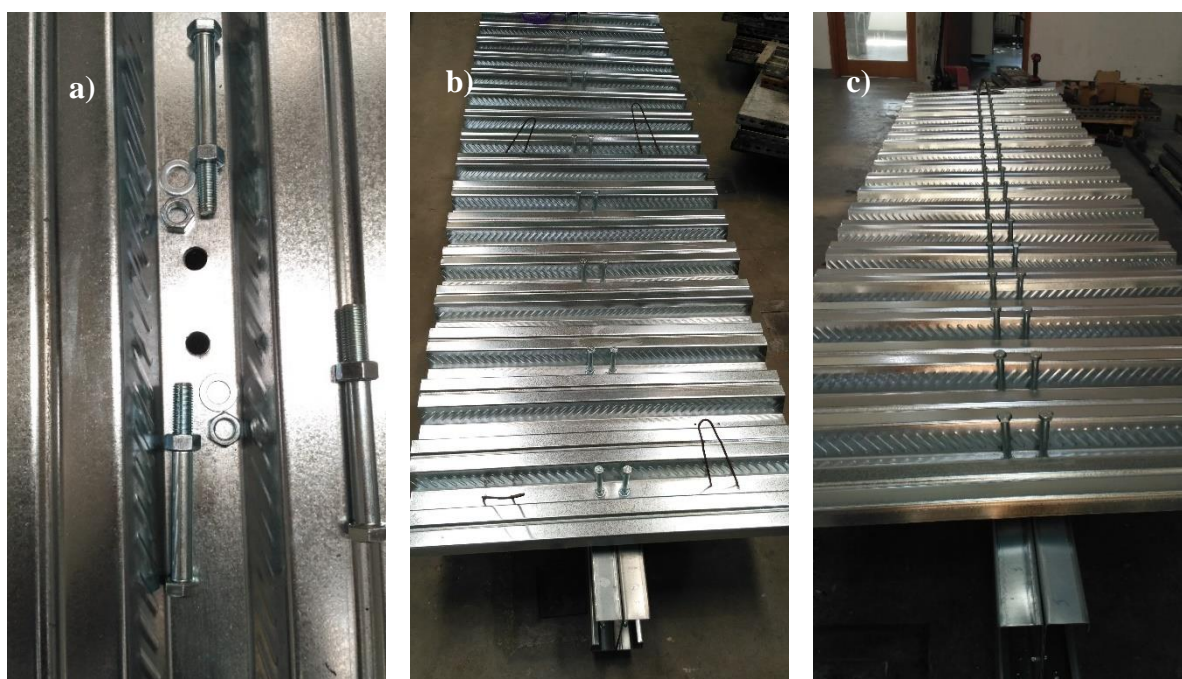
a) Esquema de aplicação do conector. b) Laje mista de conexão parcial. c) Laje mista de conexão total
